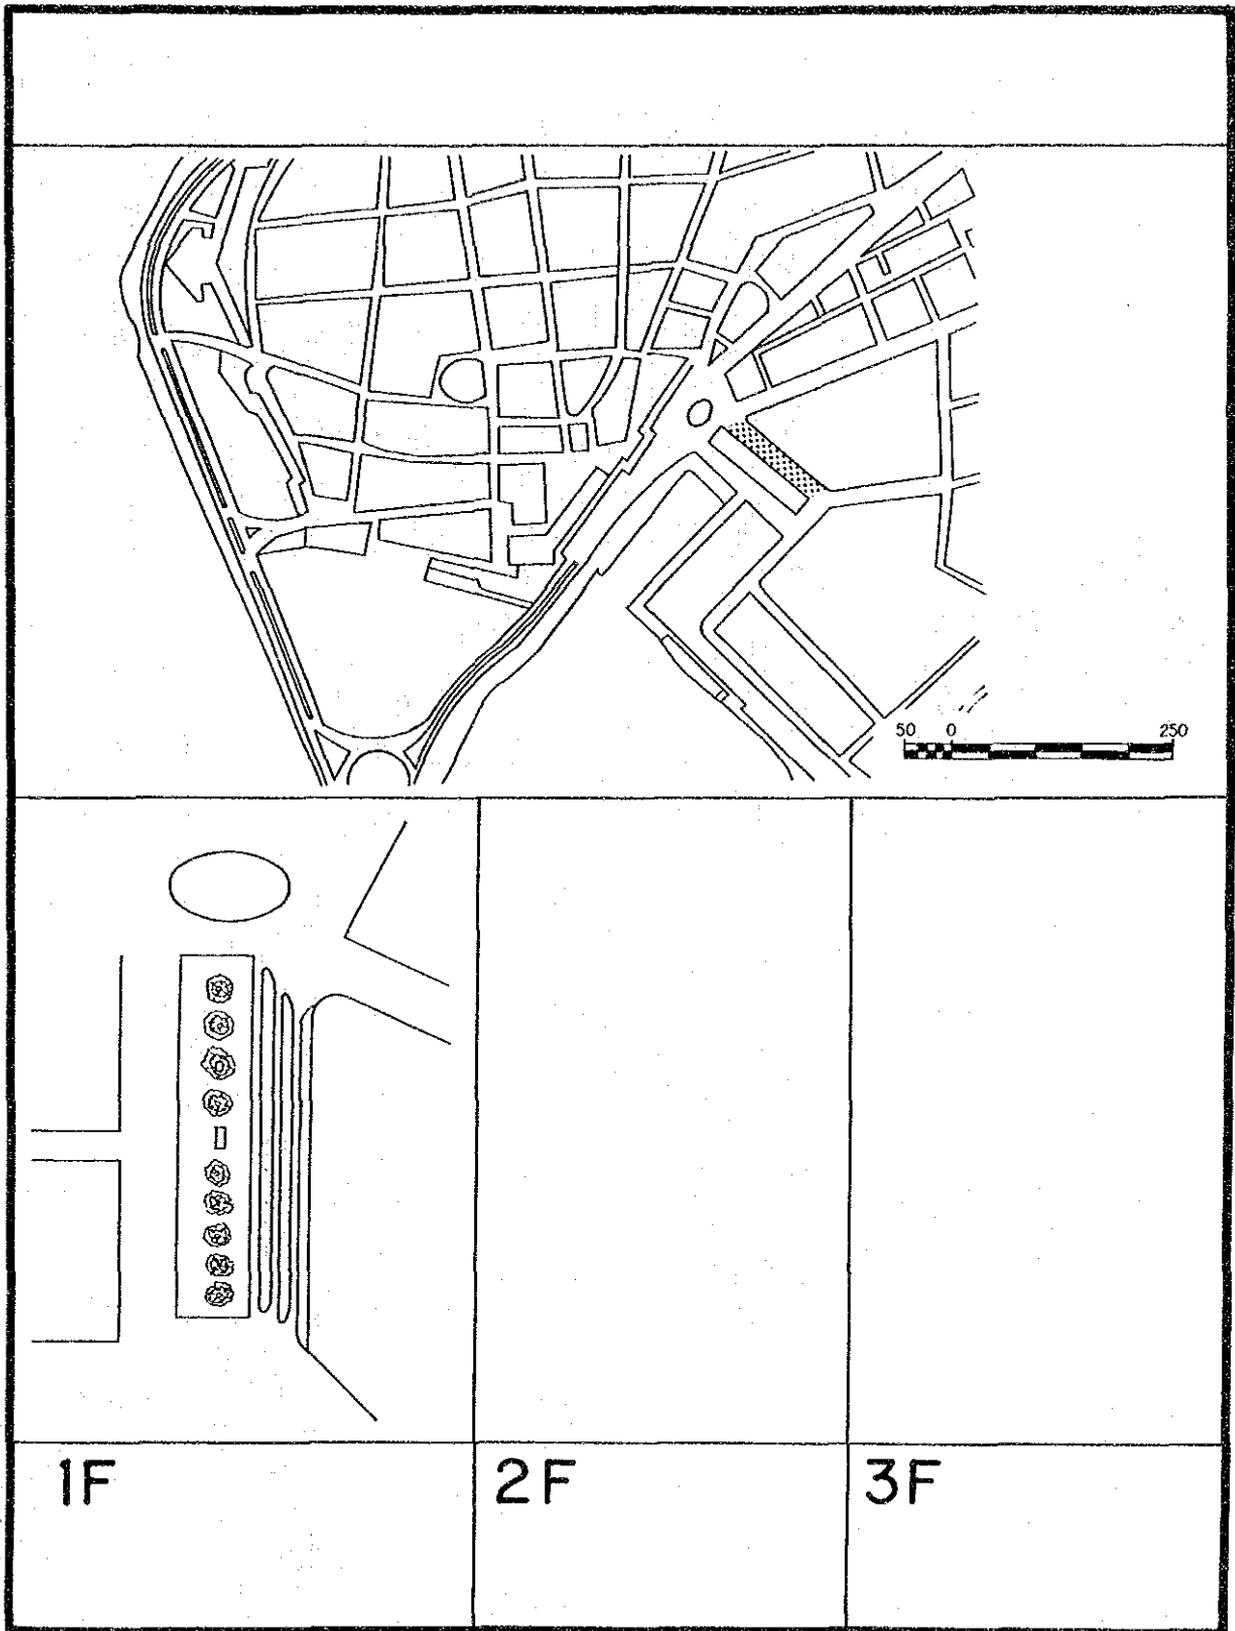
Plan de Terminal de Bus en la Parque Centenario.
